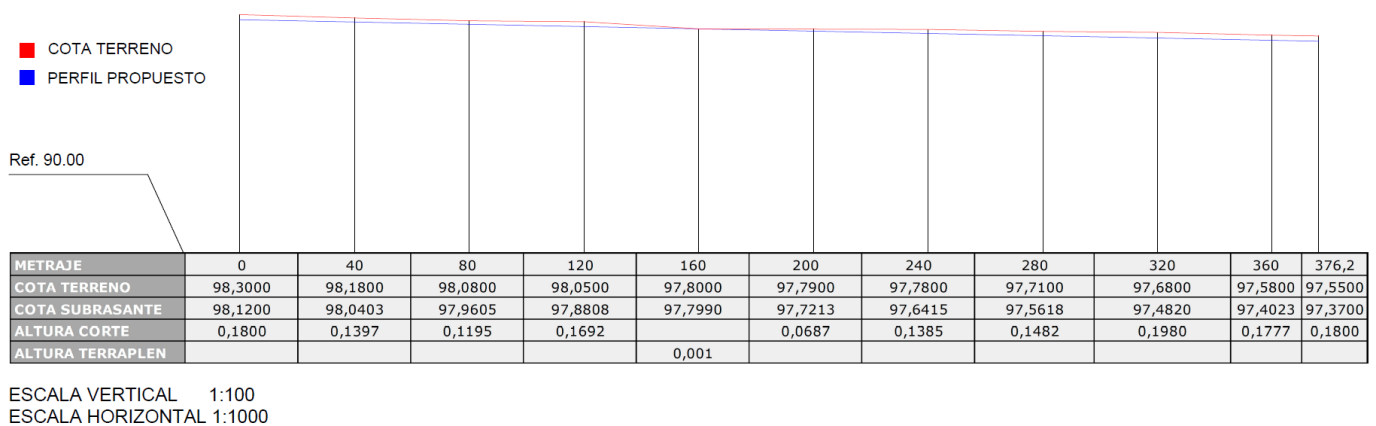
Perfil Longitudinal (Fuente Propia)
